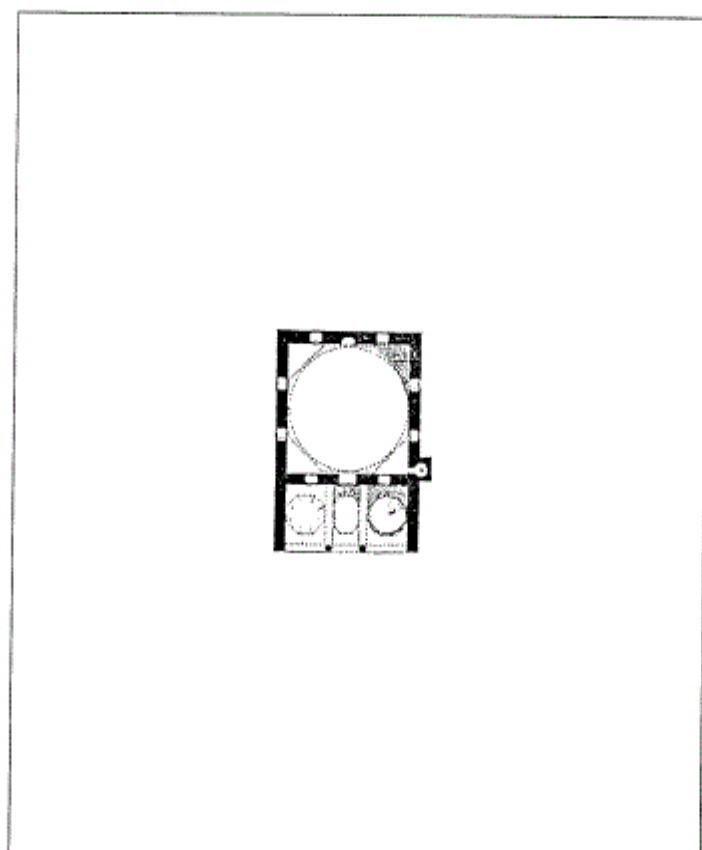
مسقط أفقي لمسجد فيروز اغا في استانبول (عن : جابريل) .
